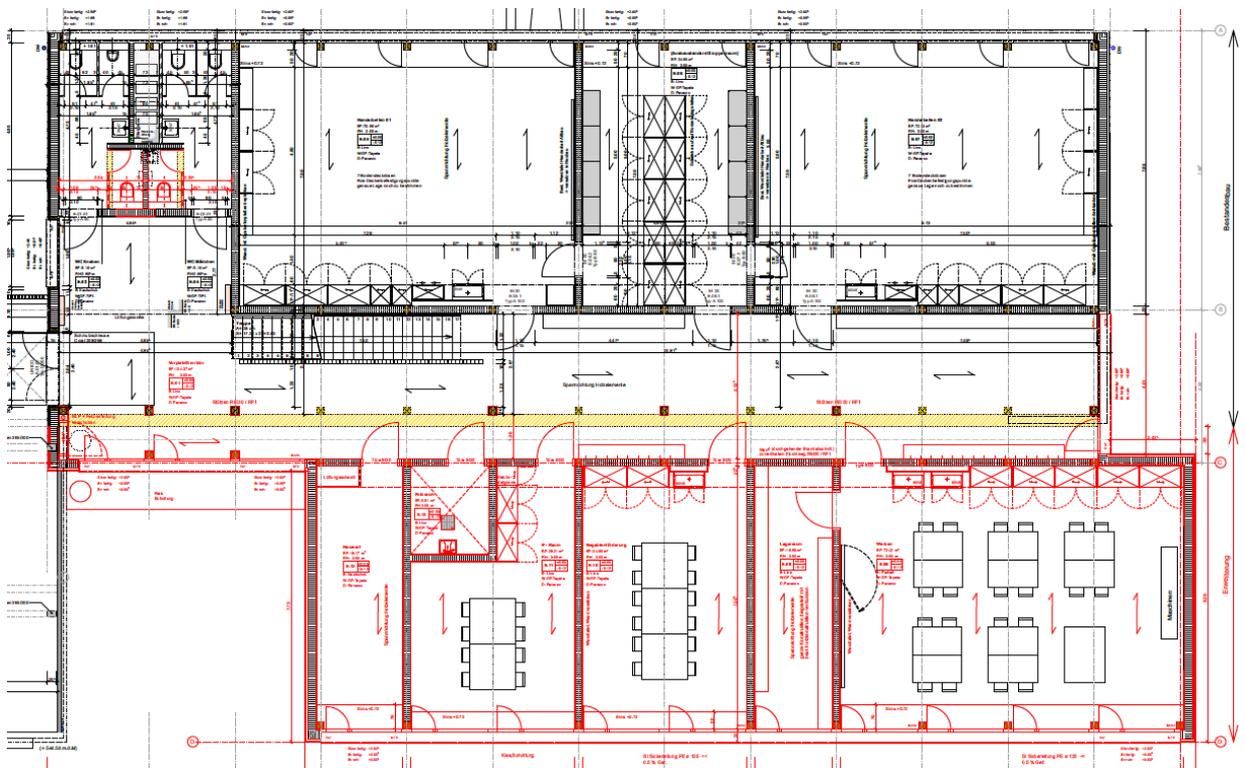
Grundriss Erdgeschoss (Planstand TU-Ausschreibung)
